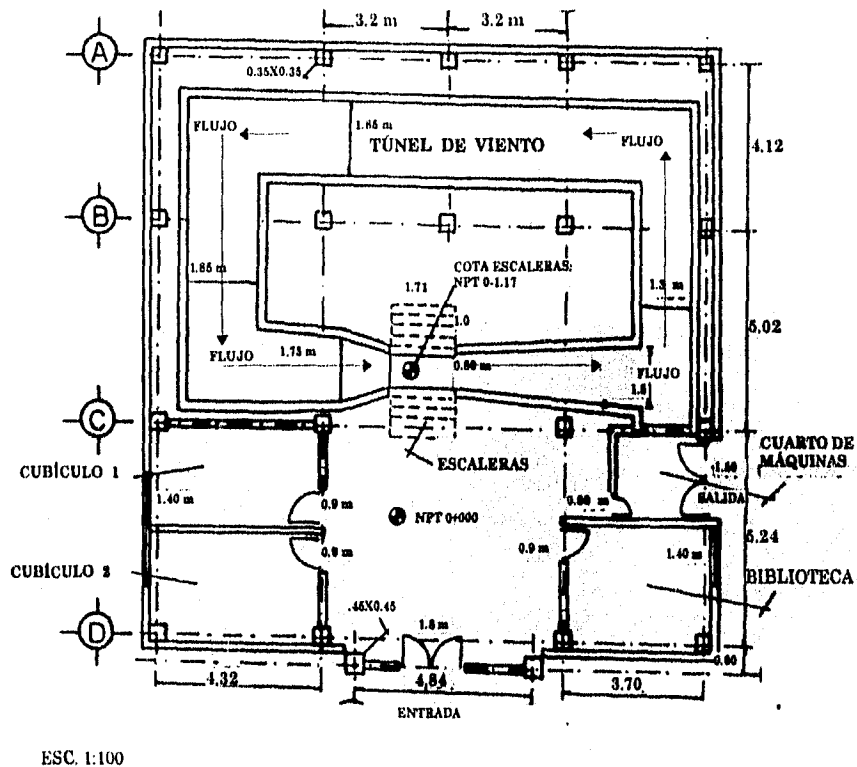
Planta arquitectónica del Laboratorio del Túnel de Viento.
